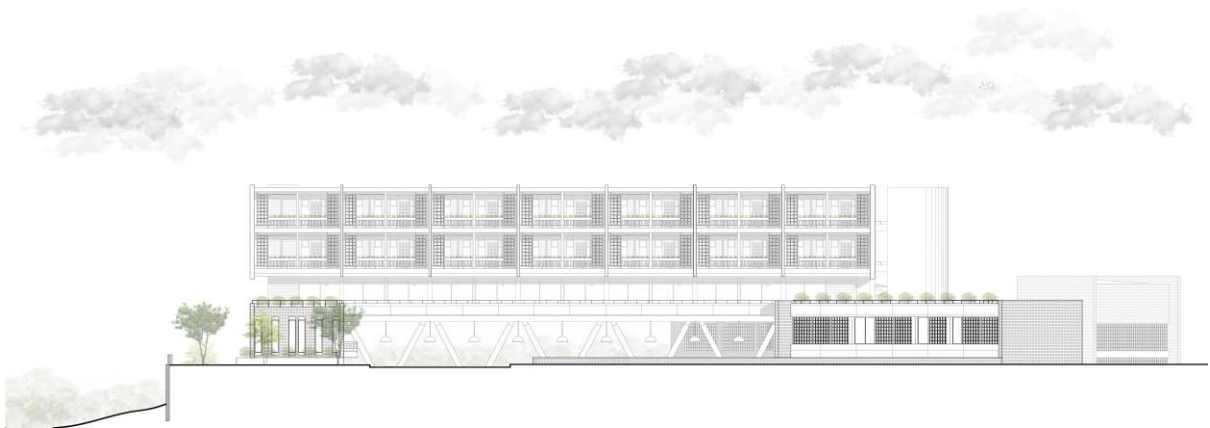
Fachada frontal – Calle Miguel Ángel. Por: Elaboración propia.
